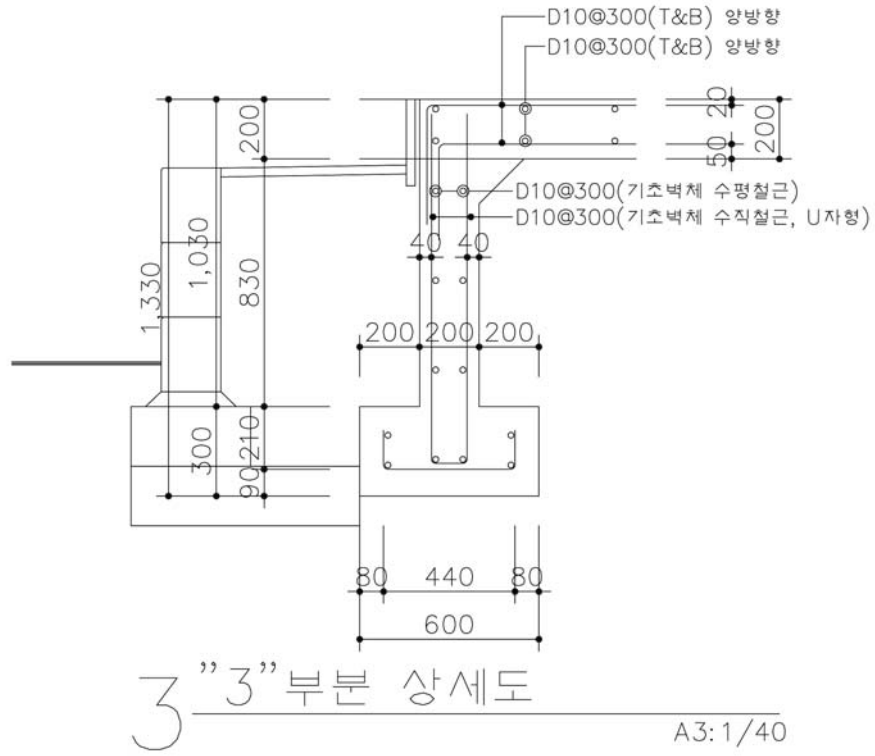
기초구조평면 상세도 3 (2-2 세세부 제공)
